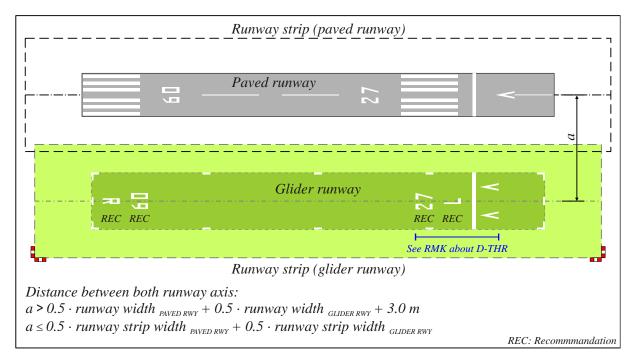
Piste planeur empiétant sur la bande de piste d'une piste revêtue
